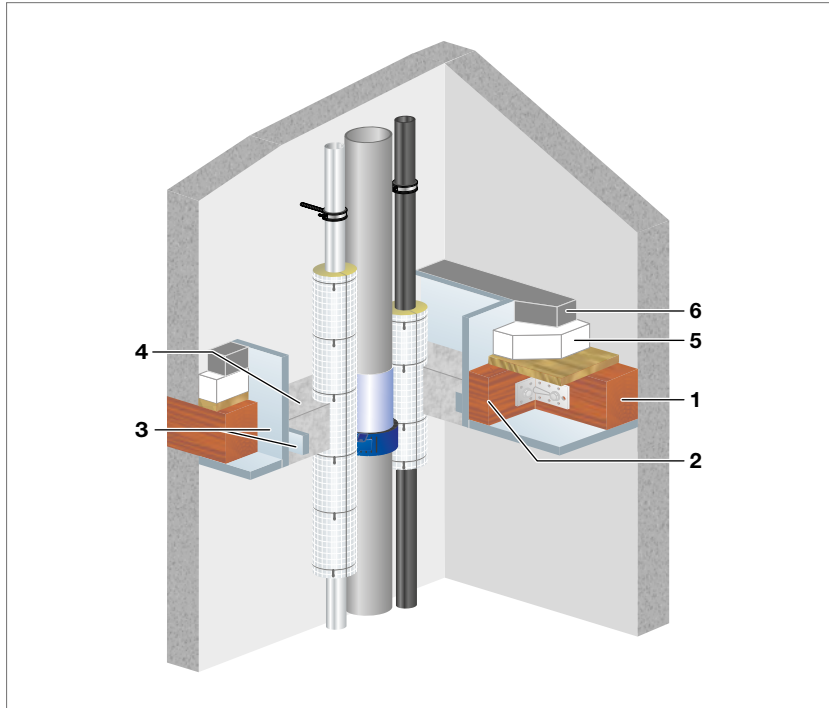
Holzbalkendecke mit Mörtelverguss „F 30“-Konstruktion
